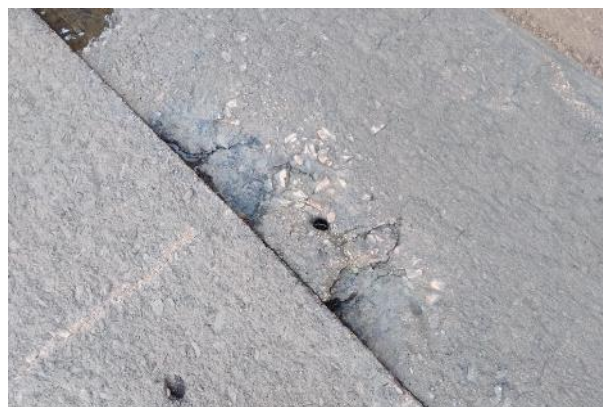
Muros Laterais – Deslocamento do concreto na base do muro, na junta com a laje
